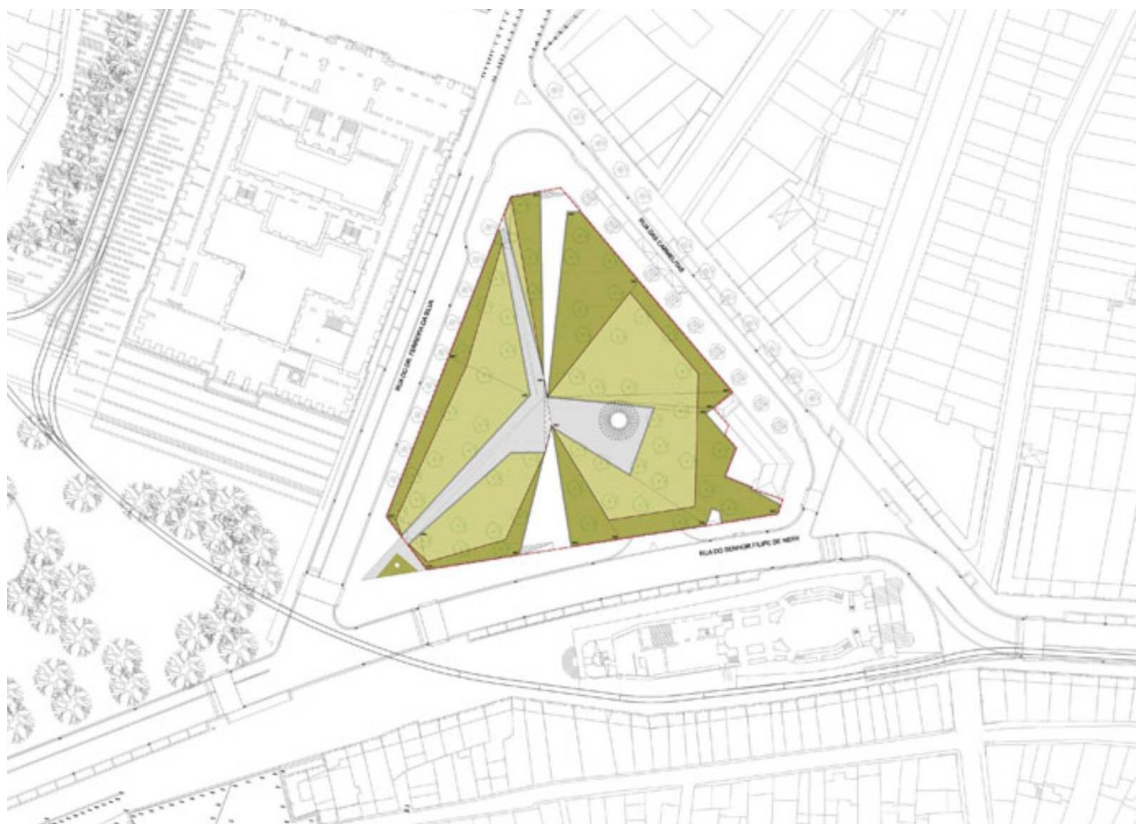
Planta de localização da Praça de Lisboa, Porto.
